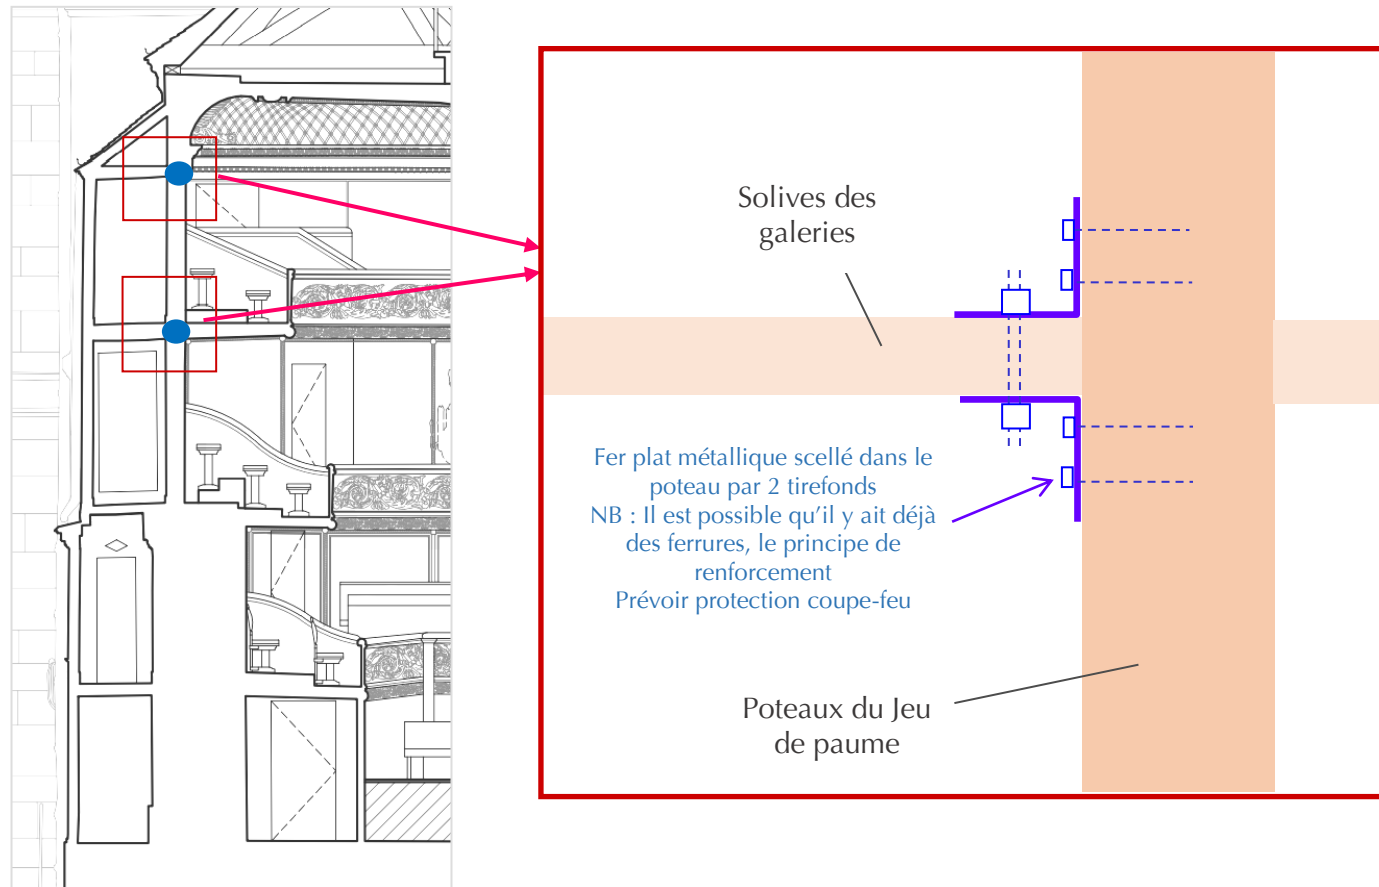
Localisation et détail de principe des assemblages à mettre en œuvre pour assurer la stabilité des galeries avec la structure d'origine du Jeu de paume - Fond de plan coupe transversale architecte
